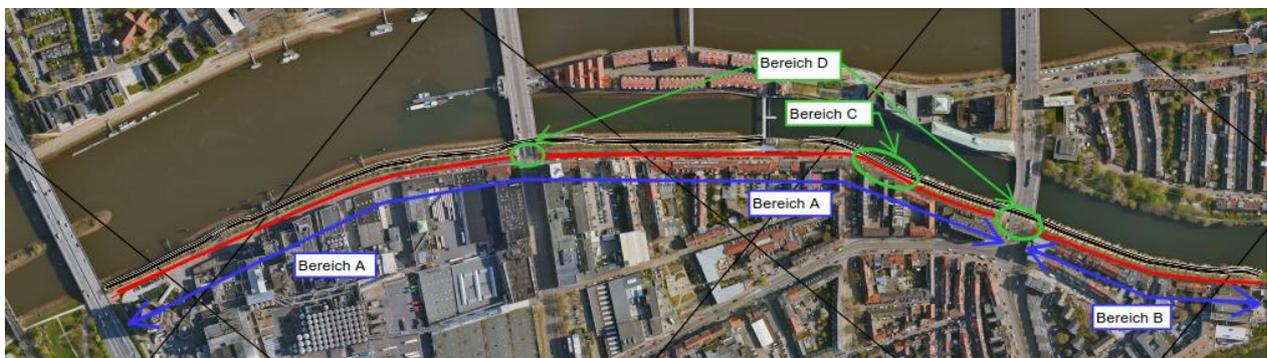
Grundriss Vorplanung CDM Smith
